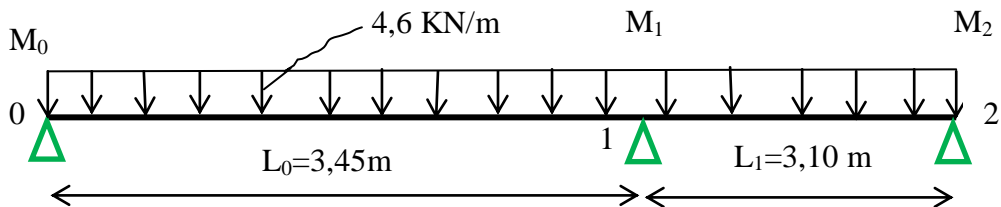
Schémas statique la poutrelle de type02 (ELU).
